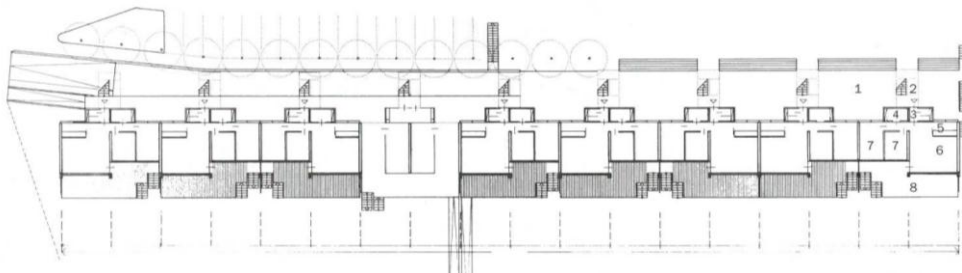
Grundriss Erdgeschoss, Haus I, o.M.
